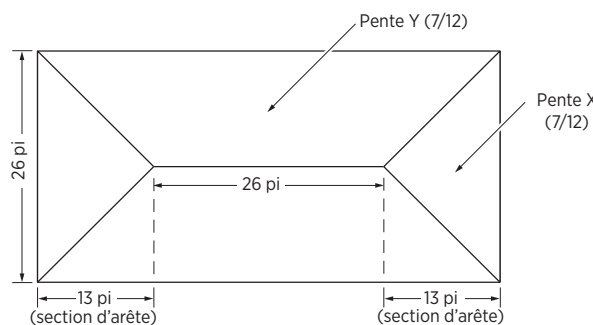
Vue en plan d'un toit en croupe classique.
